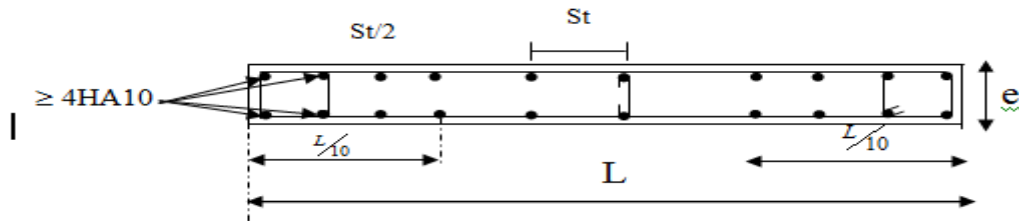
Disposition des armatures verticales dans les voiles.
